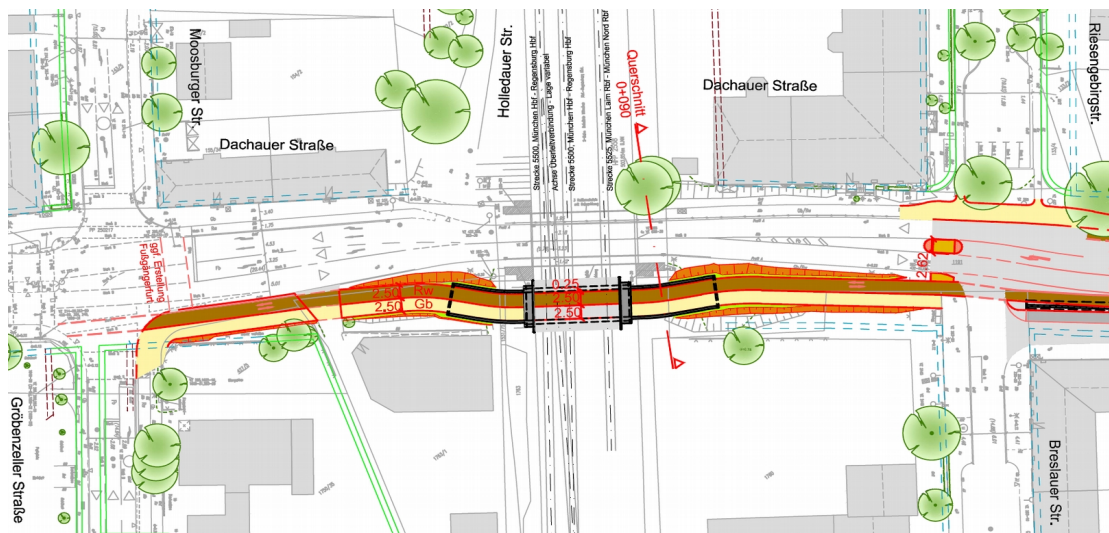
Lageplan Variante separate Fuß-Radwegunterführung
